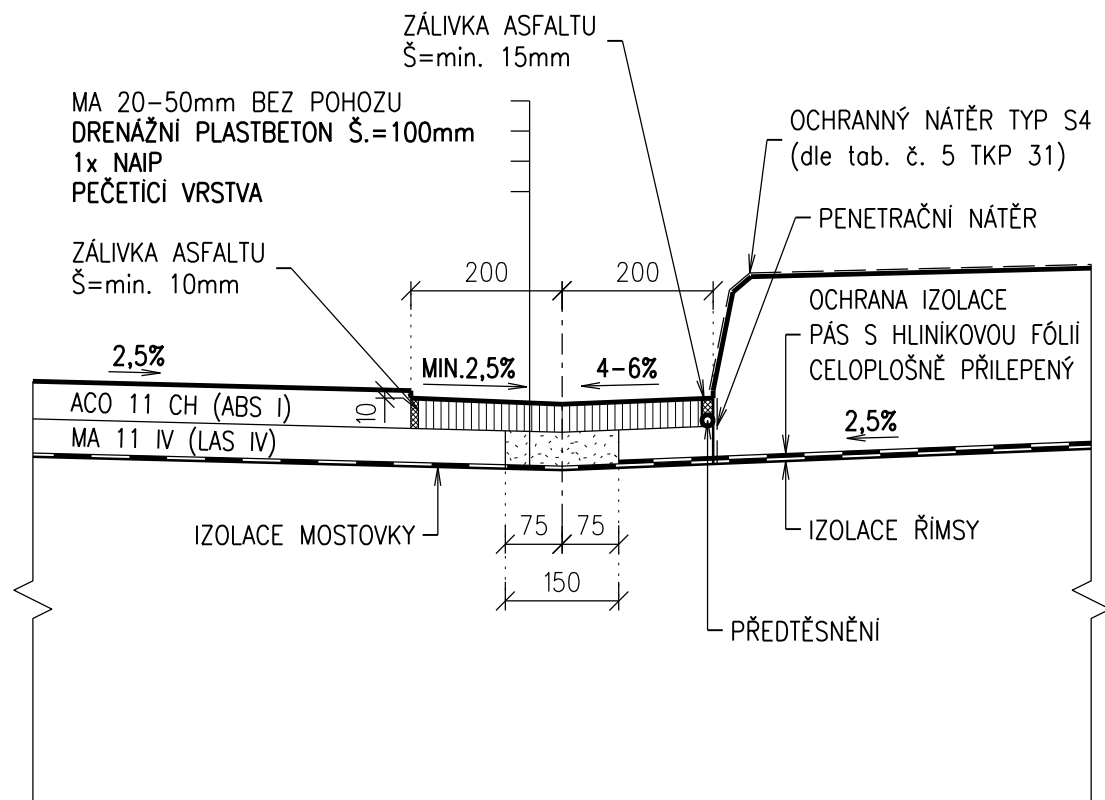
# DETAIL ODVODŇOVACÍ TRUBIČKY 1:10
